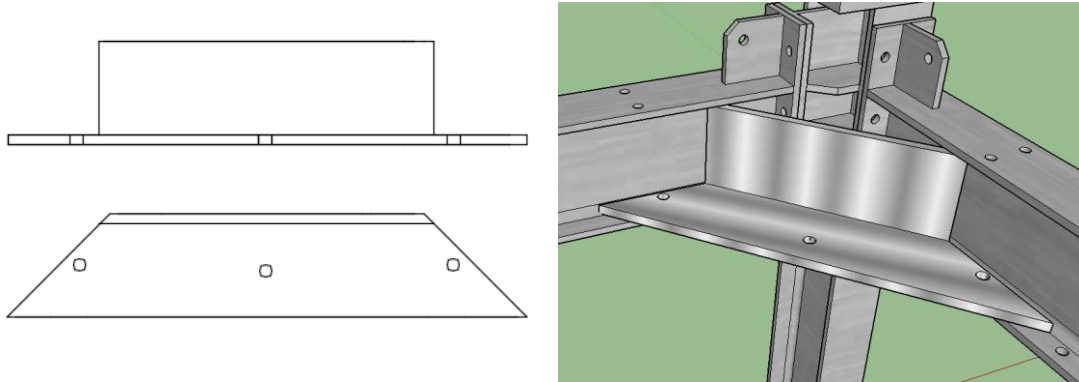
Cantoneira 80x80x8 (mm) para suporte da laje
